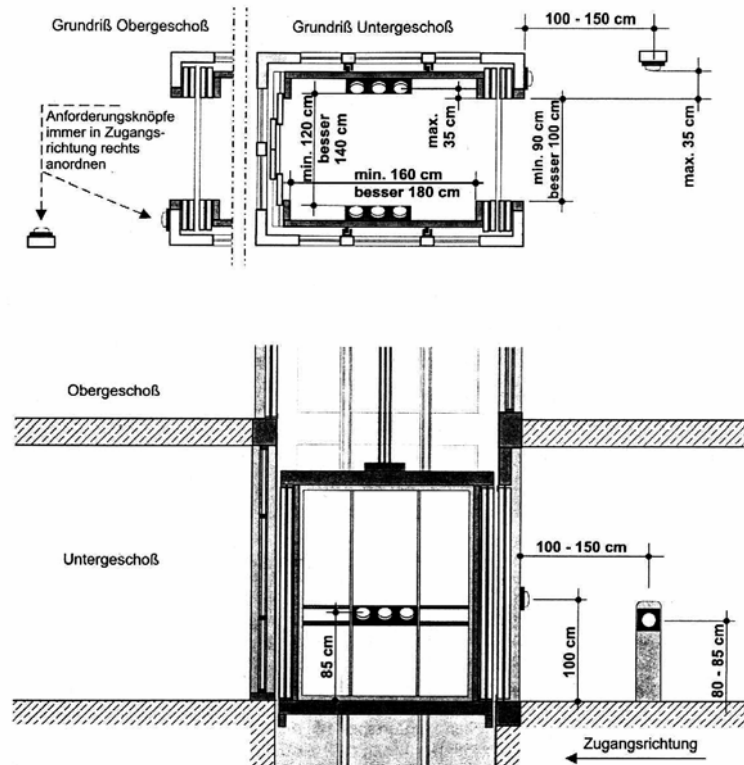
Grundriß und Schnitt Aufzug (Durchlader)
